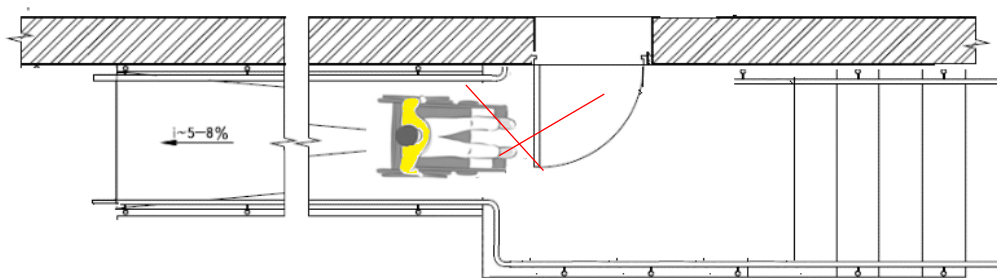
НЕПРАВИЛЬНО! Недопустимое проектное решение: площадка наверху пандуса пересекается с зоной открывания двери
